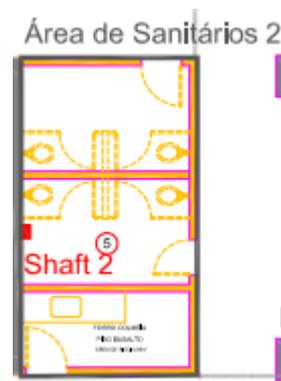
Planta de demolição – localização da área dos sanitários existente (2º pavimento)
